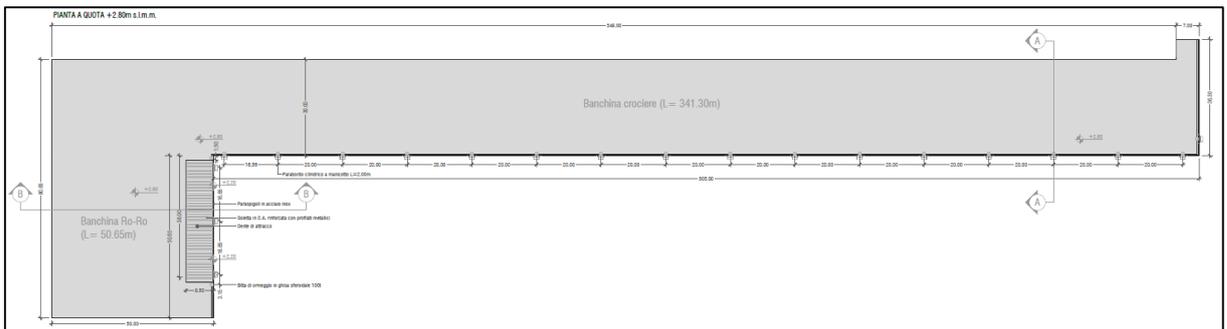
Banchina di progetto - Pianta a quota +2,80 m s.l.m., piazzale di banchina (Elab. EG.09)
